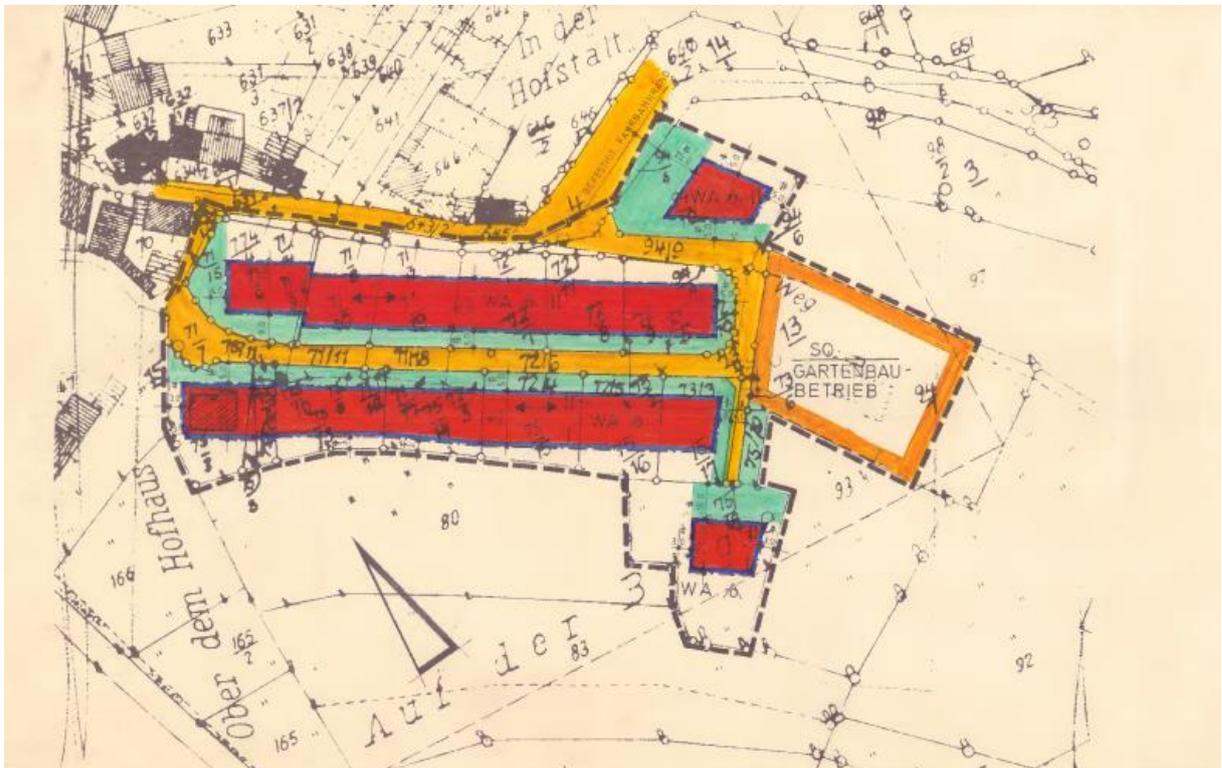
Bebauungsplan "Auf der Brögte" aus dem Jahr 1975
